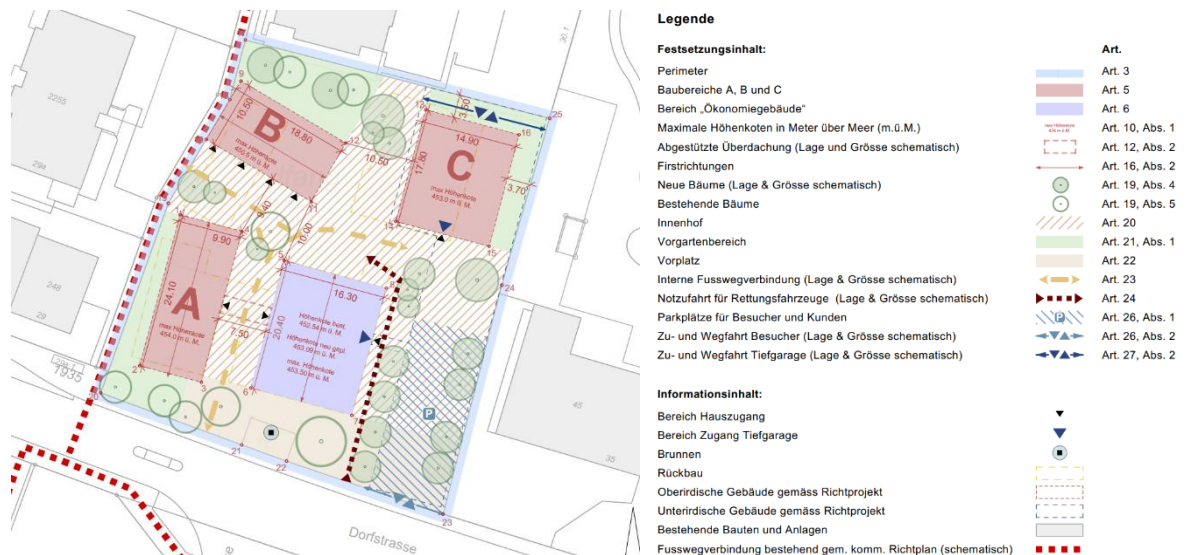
Situationsplan Privater Gestaltungsplan Dorfstrasse 31
